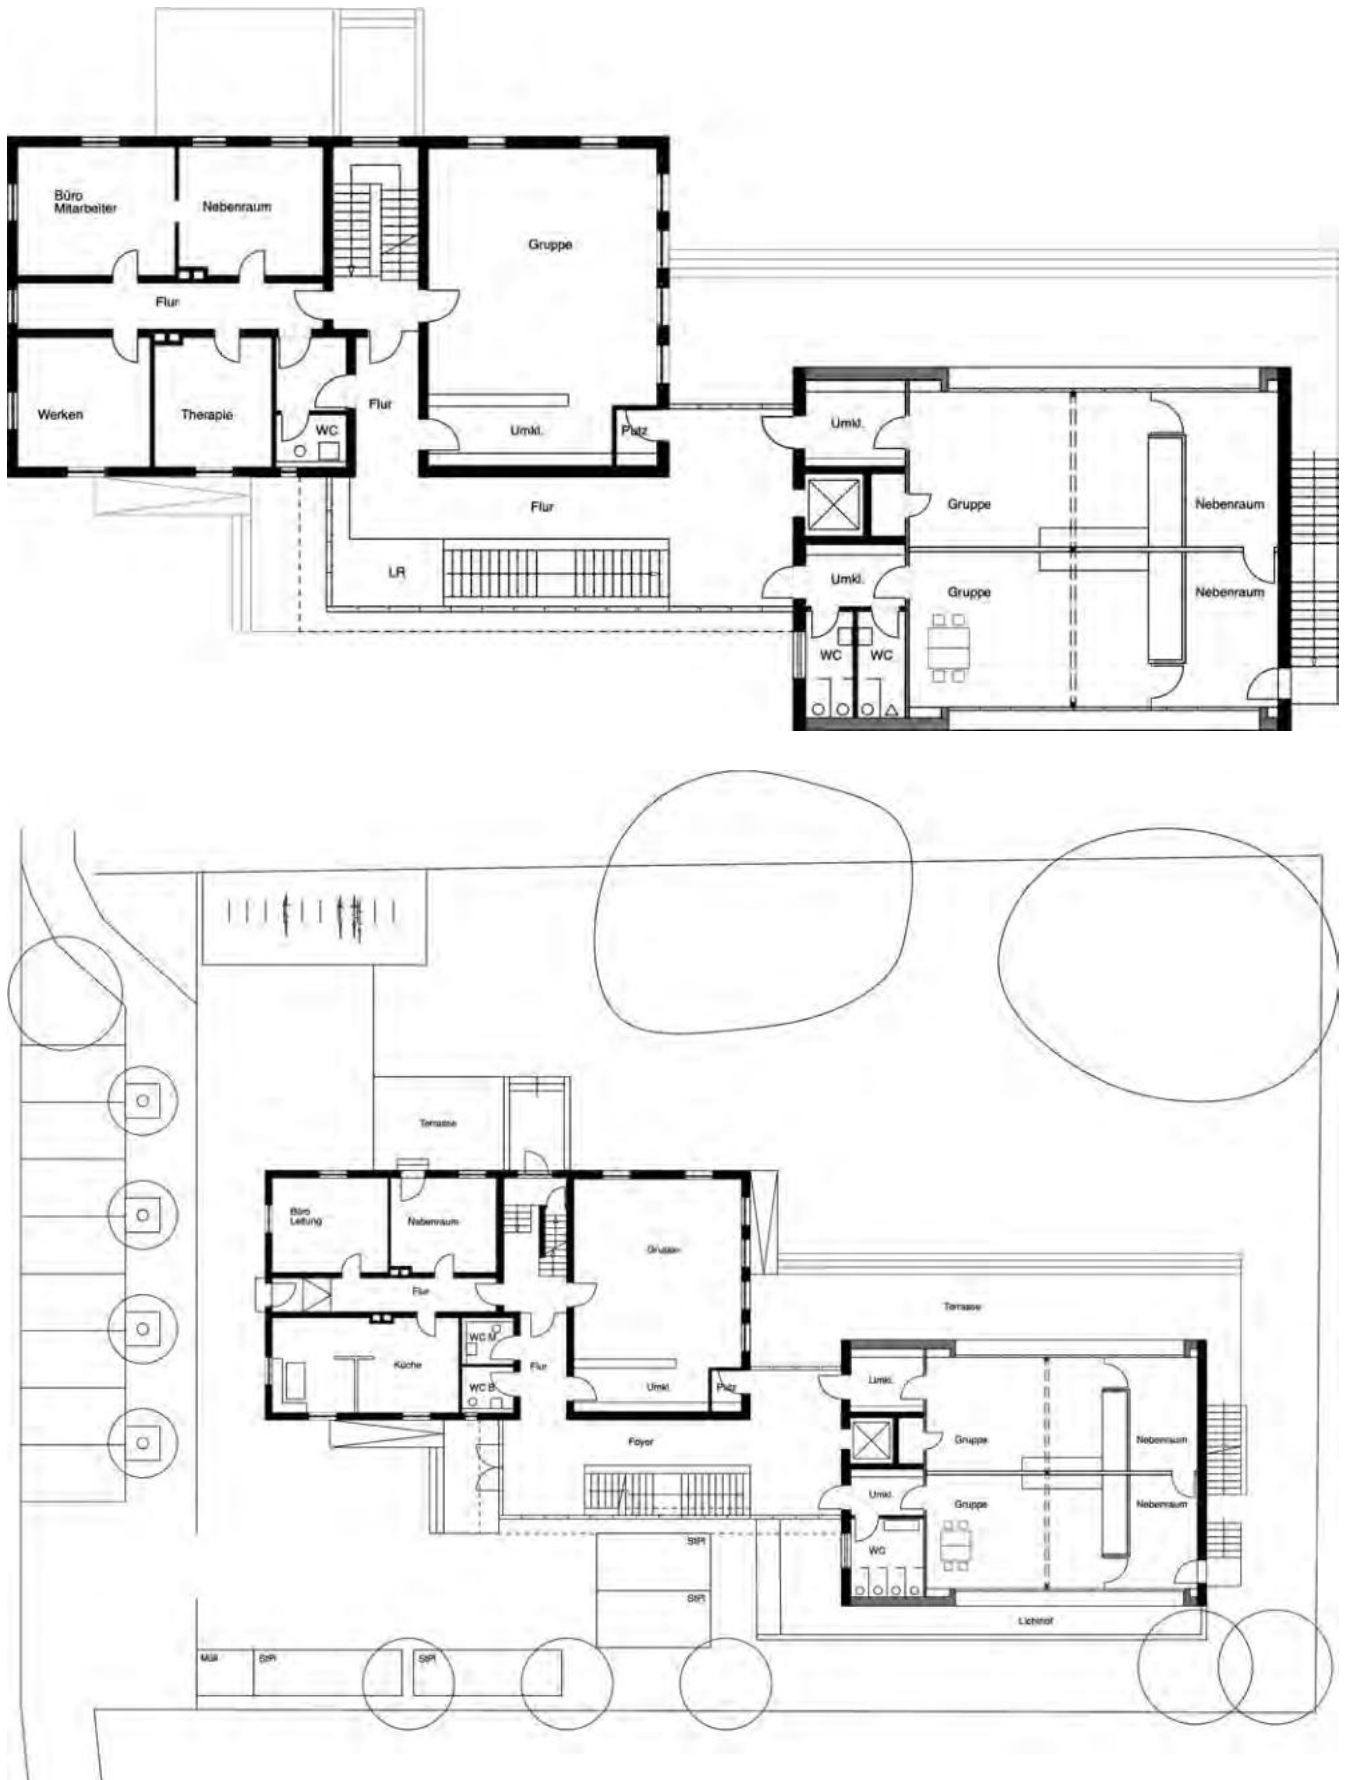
und 17: Grundrisse des Gebäudes (Foto: Stefan Dinkel)
